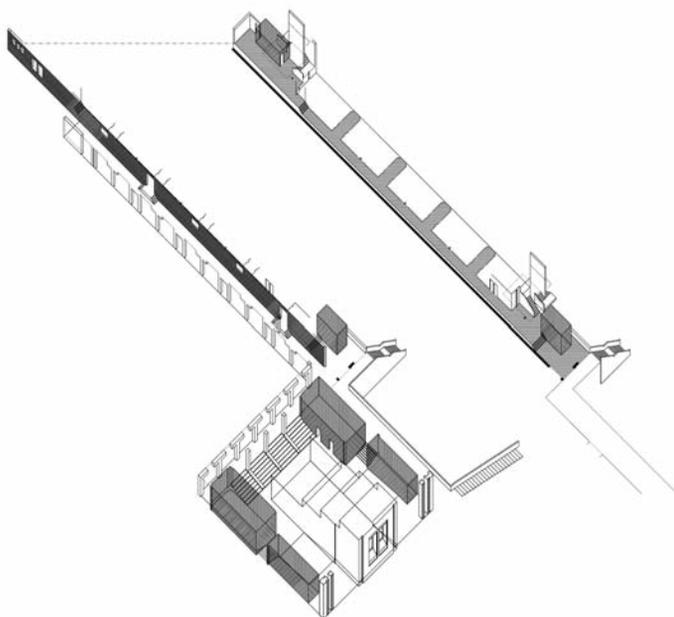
Pianta della sala consiliare. Ipotesi di progetto
